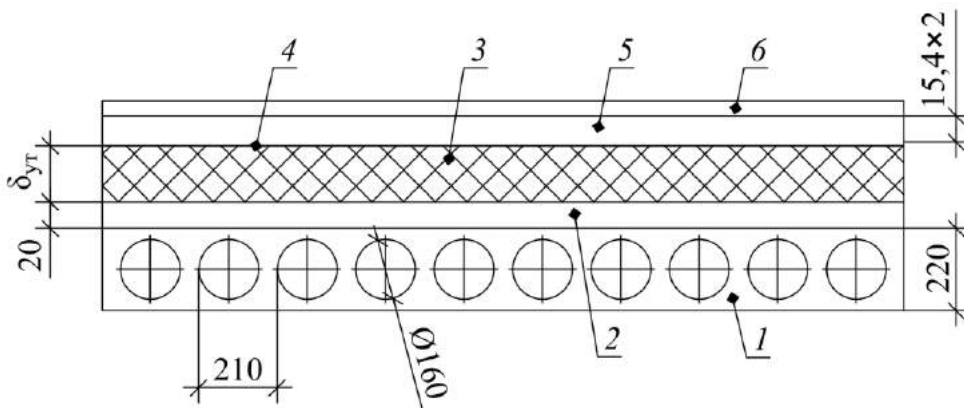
Перекрытие над неотапливаемым подвалом: 1 – железобетонная плита; 2 – цементно-песчаная стяжка; 3 – Теплоизоляция из базальтовой минеральной ваты «Флор» фирмы ISOVER; 4 – полиэтиленовая пленка; 5 – сборная стяжка из гипсоволокнистого влагостойкого листа (ГВЛВ); 6 – напольное покрытие (линолеум)
